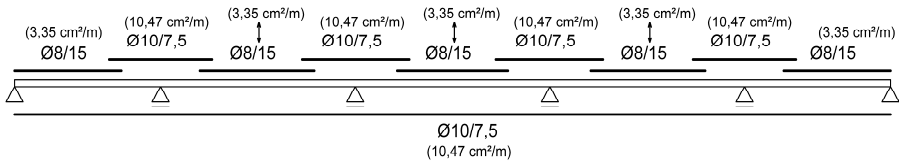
Bewehrungsskizze der erforderlichen Bewehrung zur Begrenzung der Rissbreite bei Überlagerung der Beanspruchungen infolge von Zwang und äußerer Last
